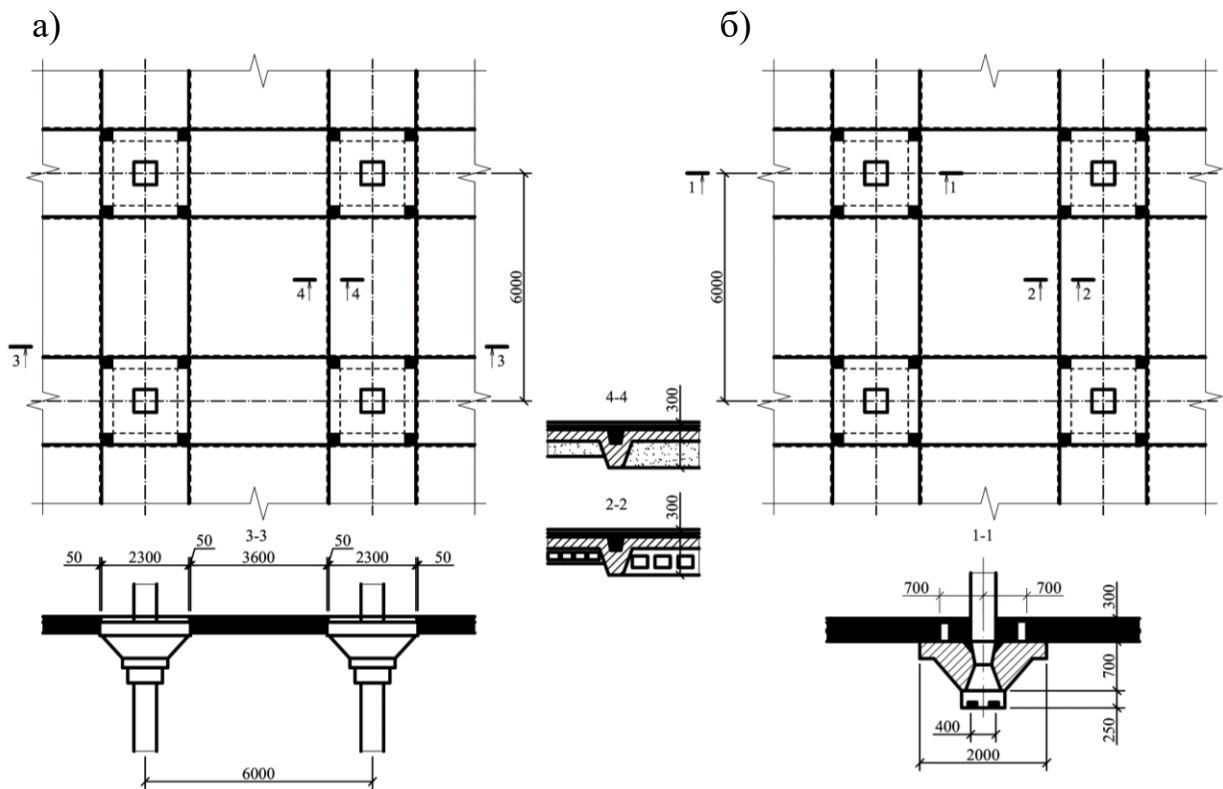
Фрагмент збірної безбалкового перекриття
